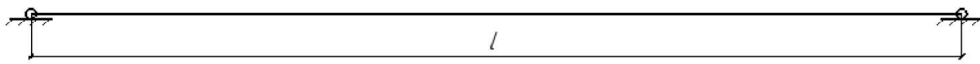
Расчетная схема нижнего пояса для расчета по методу № 1 (l — пролет ППФ)
